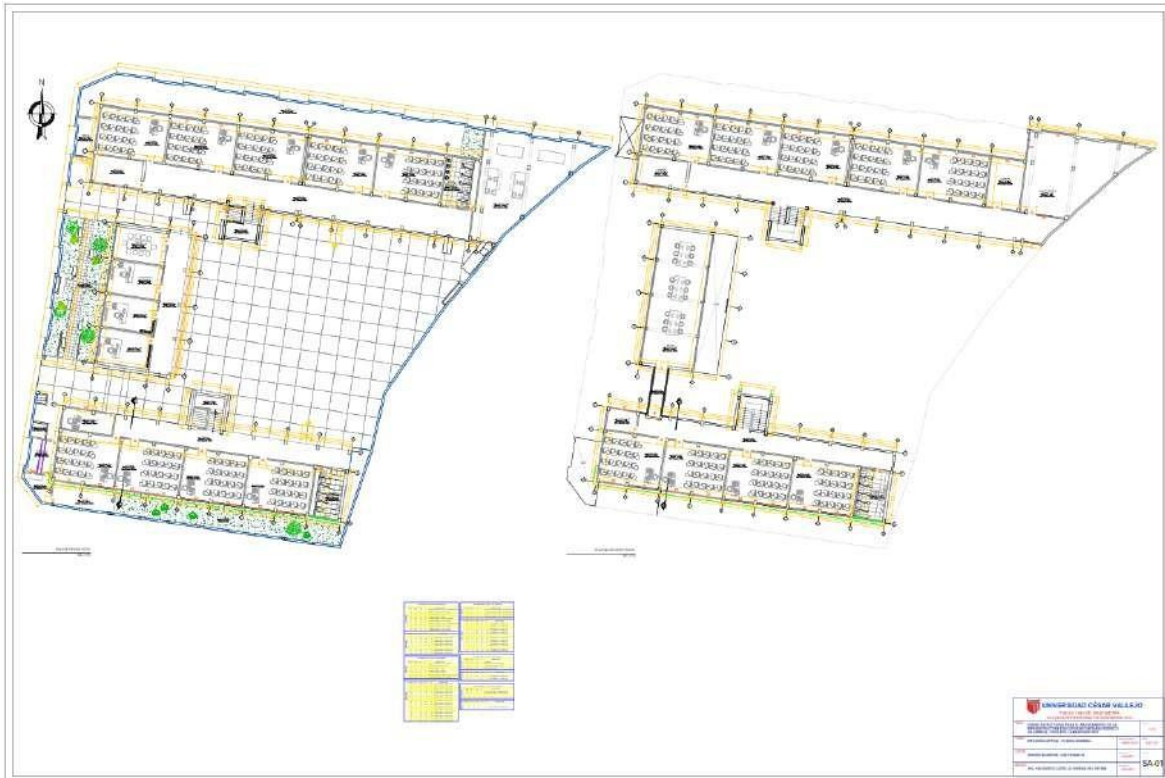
Plano SA-01: Situación actual - Planta General, 12-06-2021.
